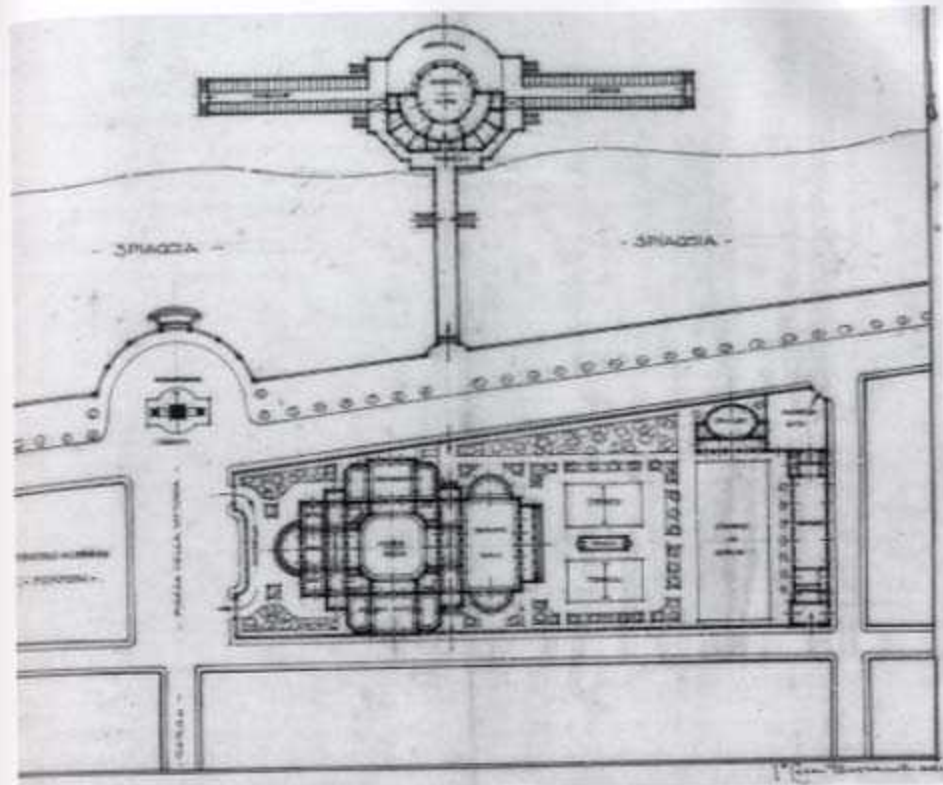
C. Bazzani. Pescara. Planimetria del progetto per la sistemazione di piazza Vittoria (ibidem).
